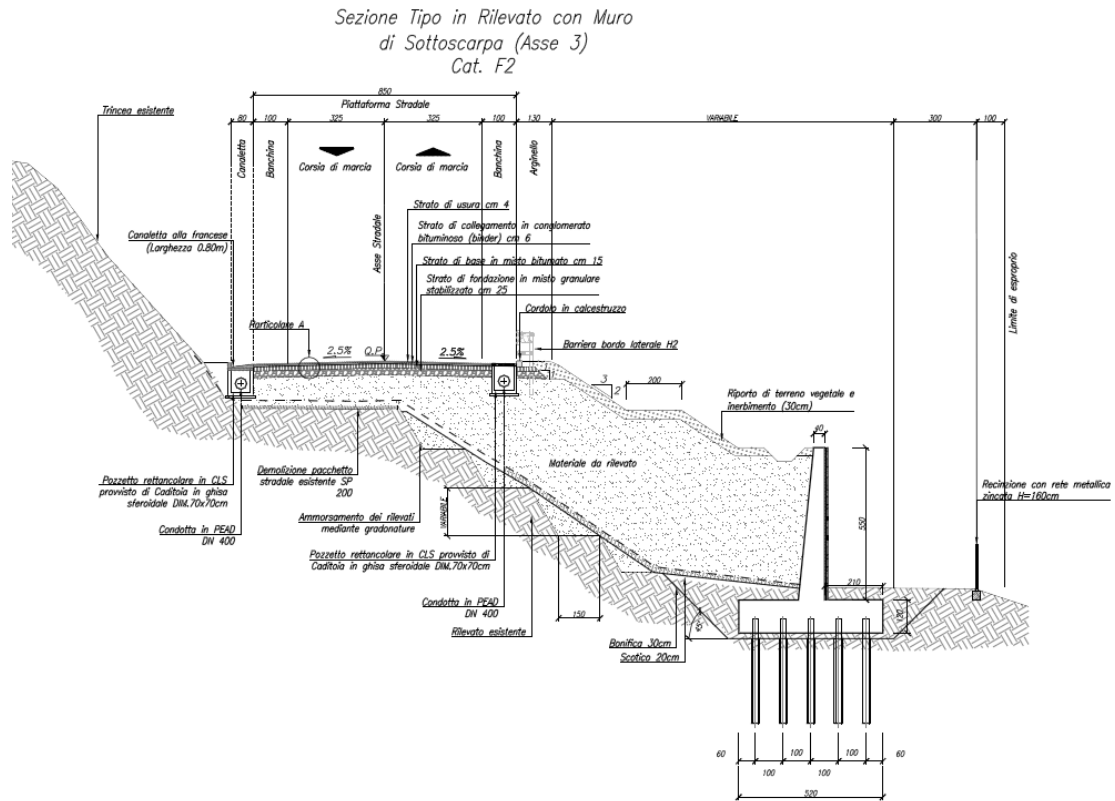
sezione tipo C2 in mezza costa con ammassamento su rilevato esistente e muro di sottoscarpa.
